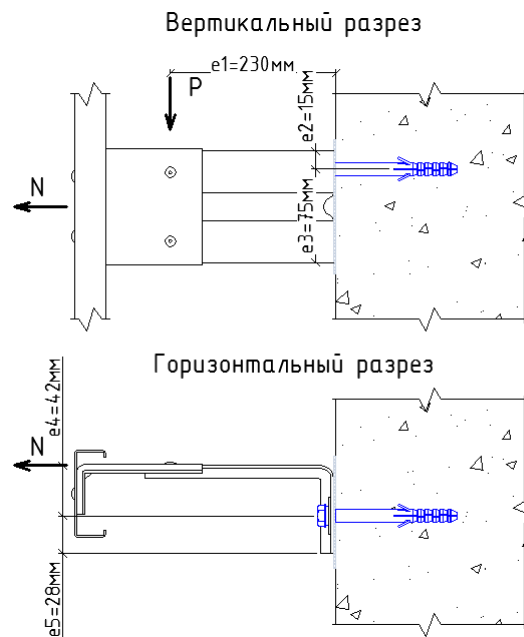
Расчётная схема проверки анкерного элемента на вырыв
